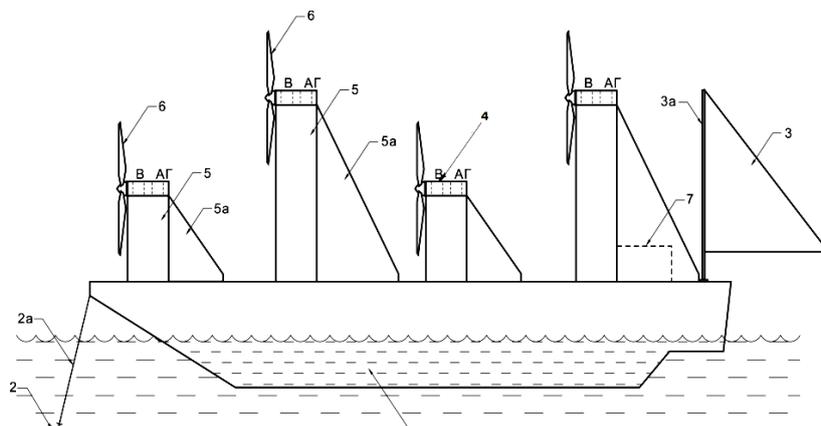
Общий вид ветрофермы на плавающем фундаменте.
